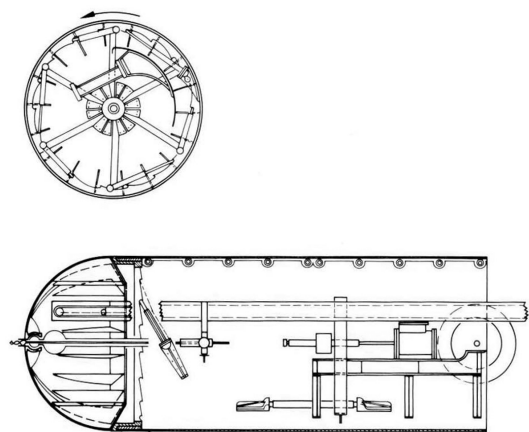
da [7] – Scudo meccanizzato brevettato da J. BRUNTON e G. BRUNTON 1876.
